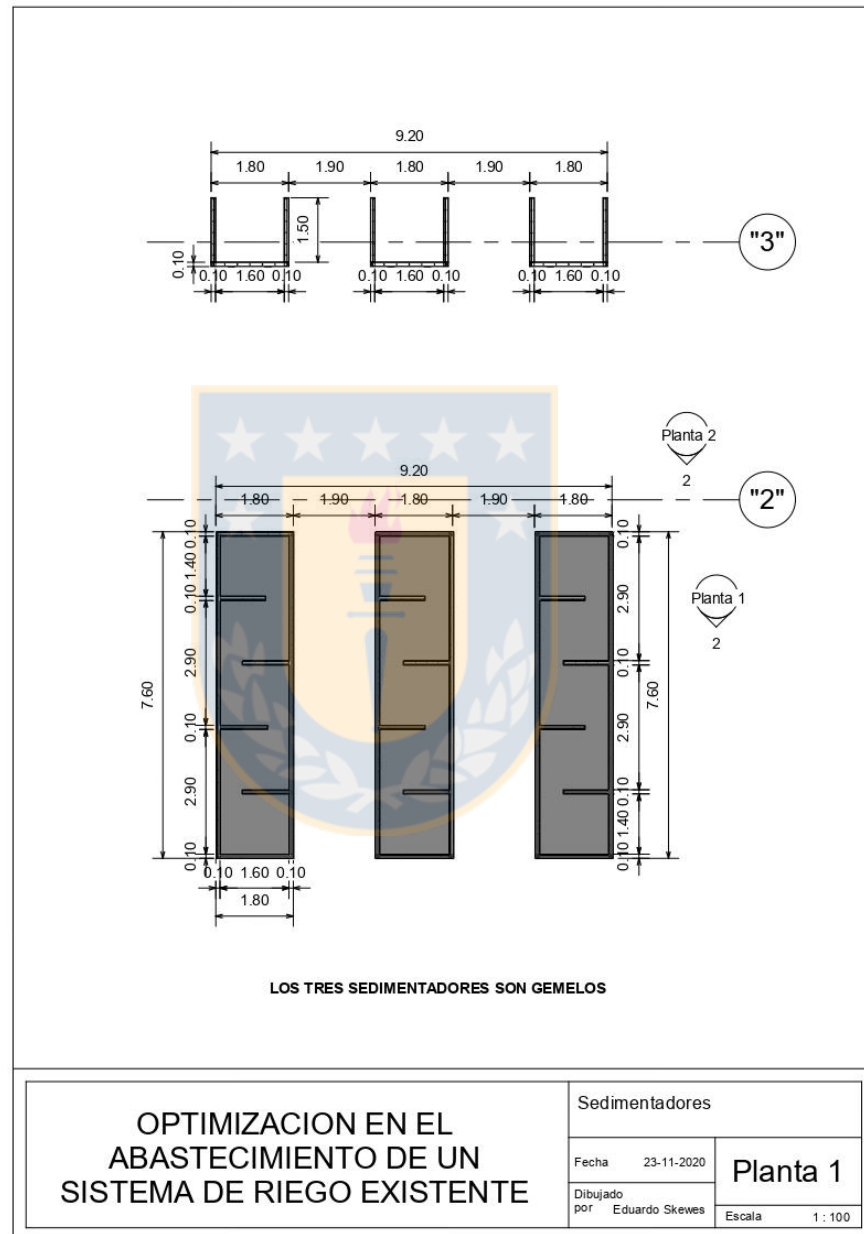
Plano de planta de sedimentador. Fuente: Elaboración propia.
